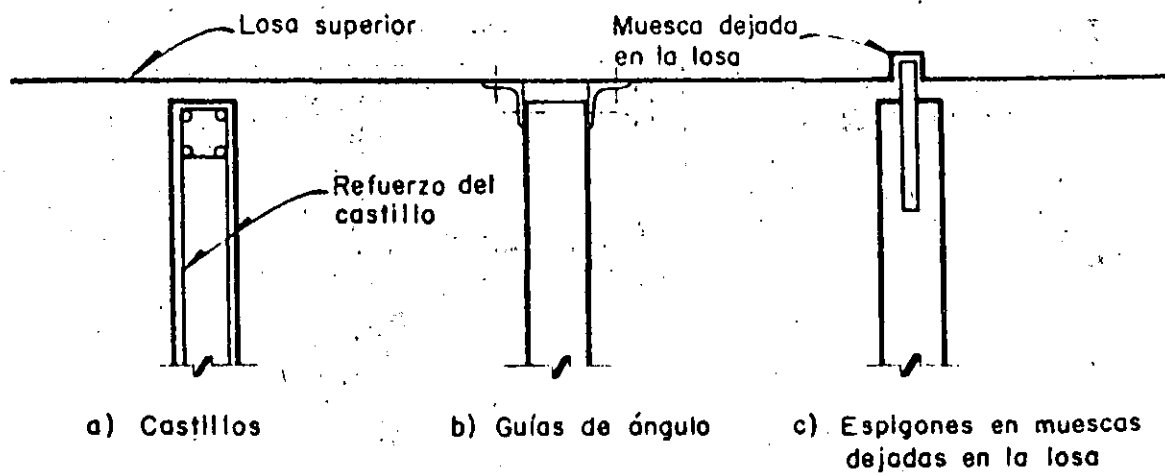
Algunos procedimientos para desligar muros de mampostería
